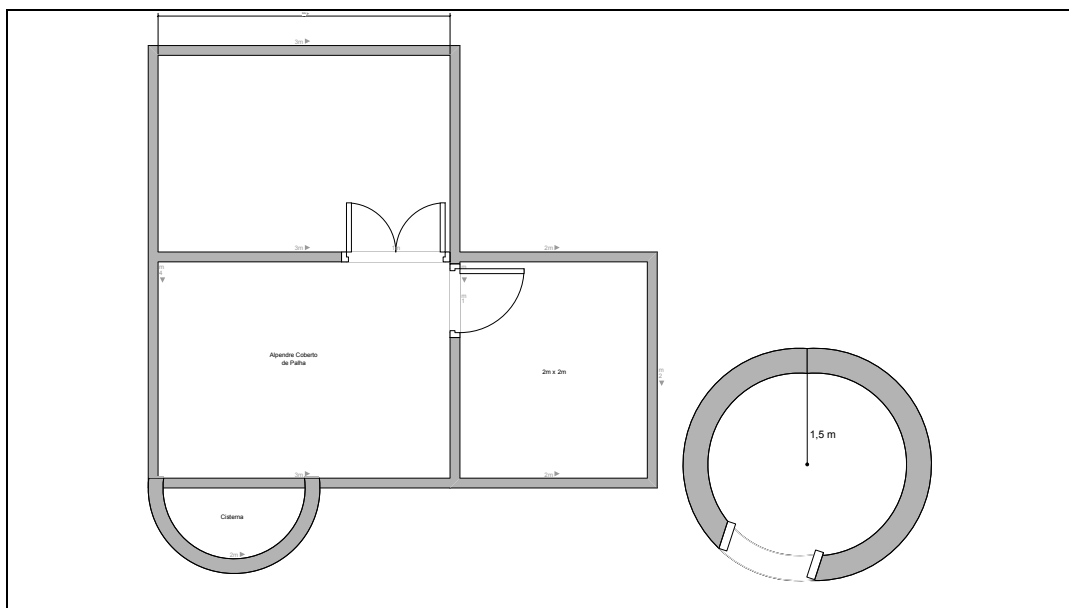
Planta reconstituída do funco e da casa de planta rectangular localizados em Alto Vicente.
